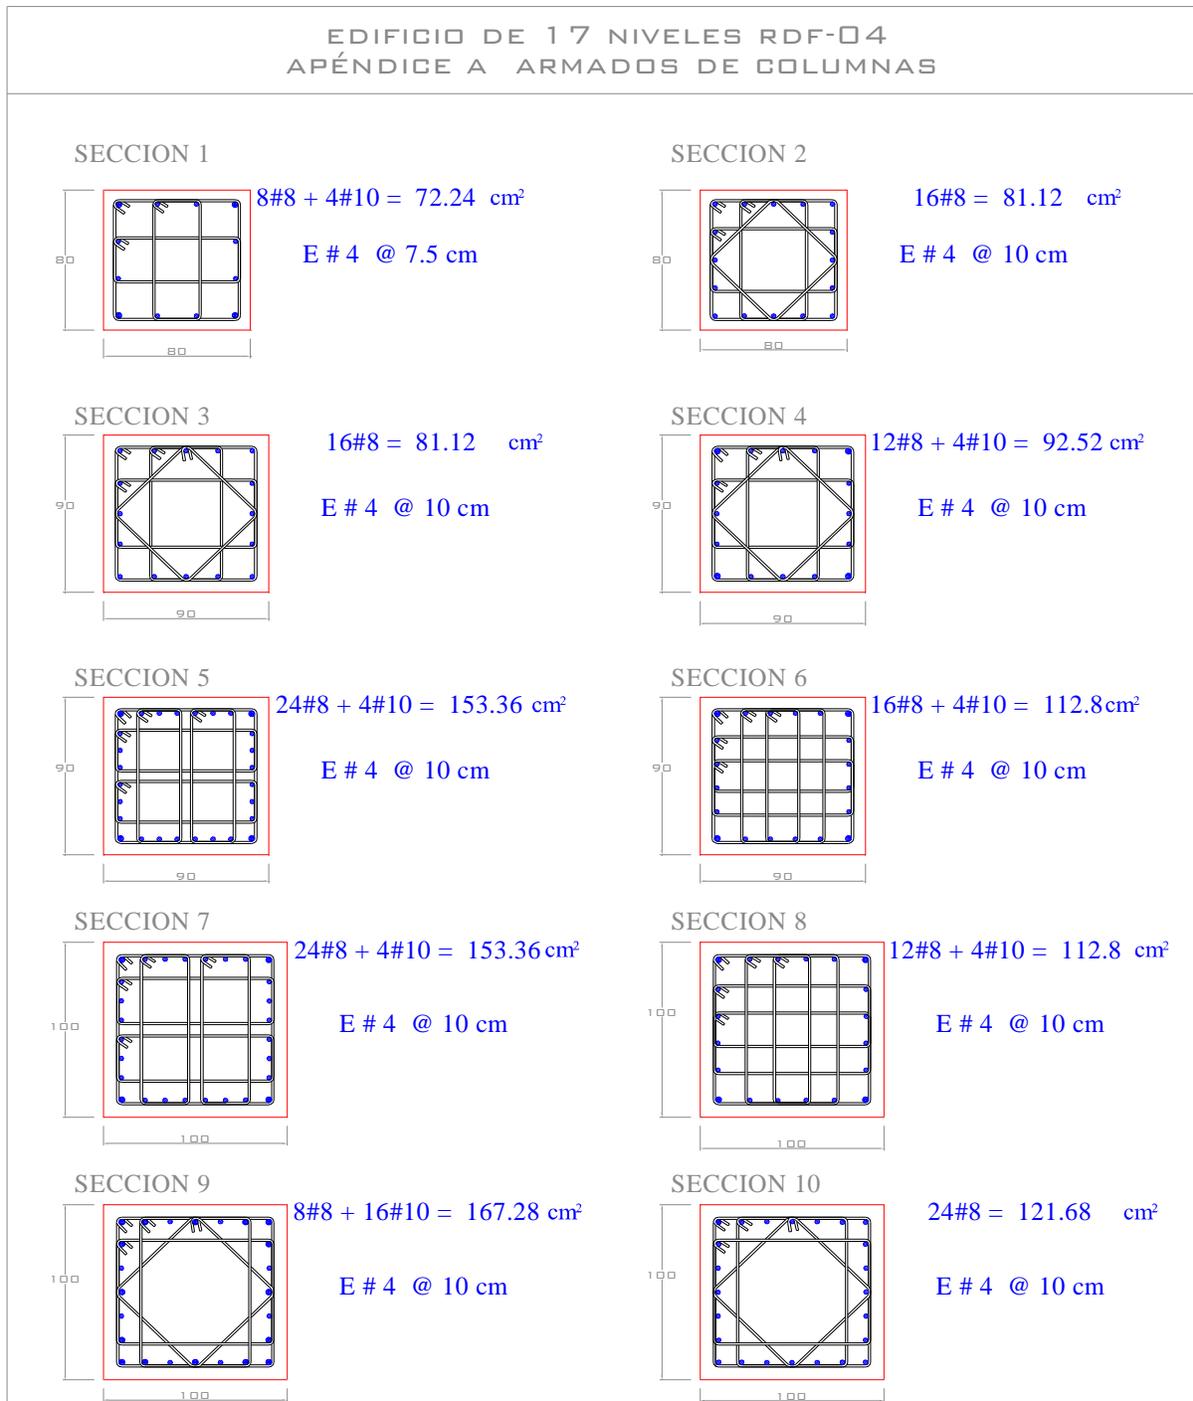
Armados de acero longitudinal y transversal propuestos en columnas, edificio 17 niveles, Apéndice A (caso B) de las NTC-Sismo, RDF-04
